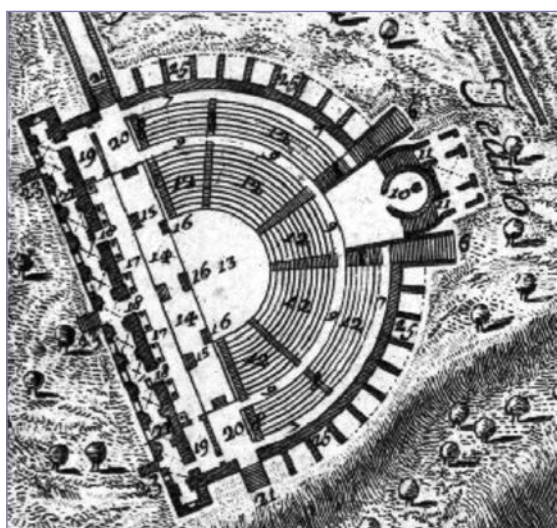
"Odeón" en la planta final de la planta de Piranesi (MACDONALD y PINTO 1995: 258).
